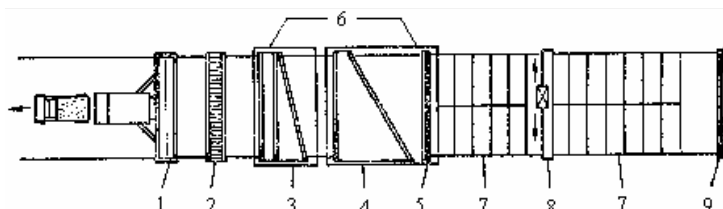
Schema utilajelor care se folosesc la execuția îmbrăcăminților din beton de ciment realizate într-un singur strat: 1 - utilaj de așternere, compactare și nivelare; 2 - utilaj cu platformă pentru montarea ancorelor; 3 - nivelator finisor; 4 - utilaj de finisare; 5 - trecere cu mătura; 6 - corturi de lucru; 7 - corturi de protecție; 8 - dispozitiv pentru aplicarea produselor de protecție; 9 - utilaj pentru tăierea rosturilor transversale și longitudinale.
